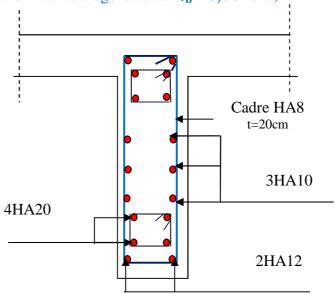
Schéma de ferraillage du linteau Pour les étages (sauf 9 et10).
